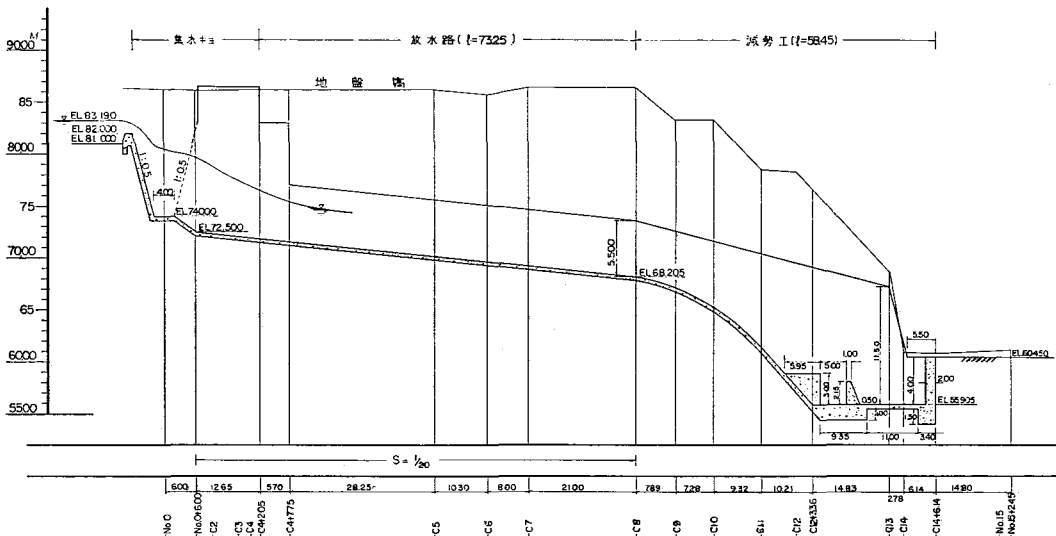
千葉県小糸川地区三島ダム余水吐縦断面図
